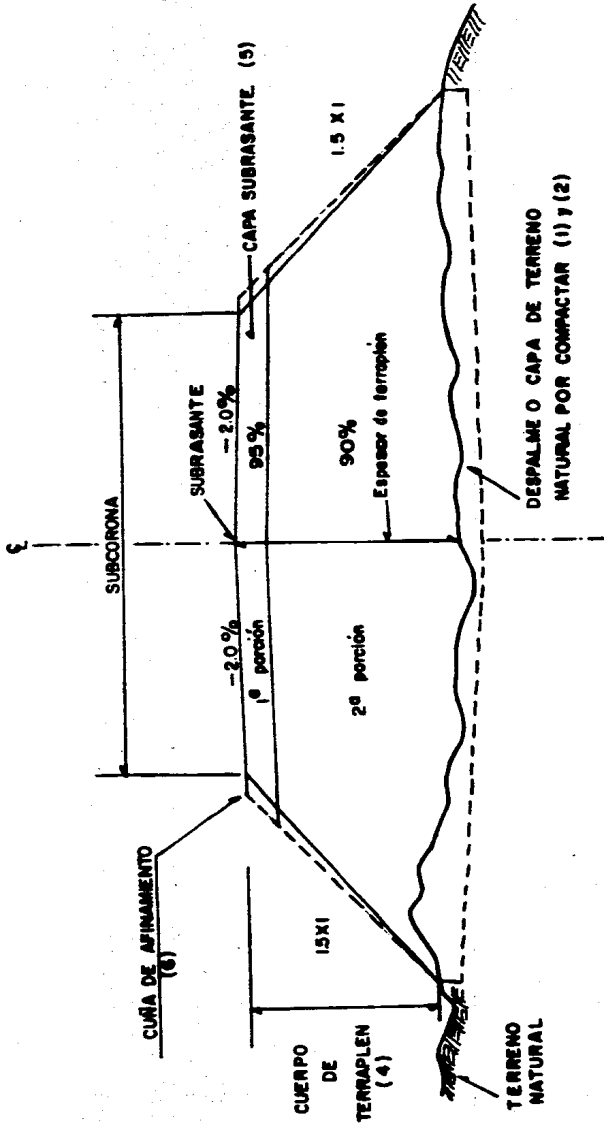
SECCION TRANSVERSAL TIPICA CONTENENDO ALGUNOS ELEMENTOS DEL GRUPO B.
